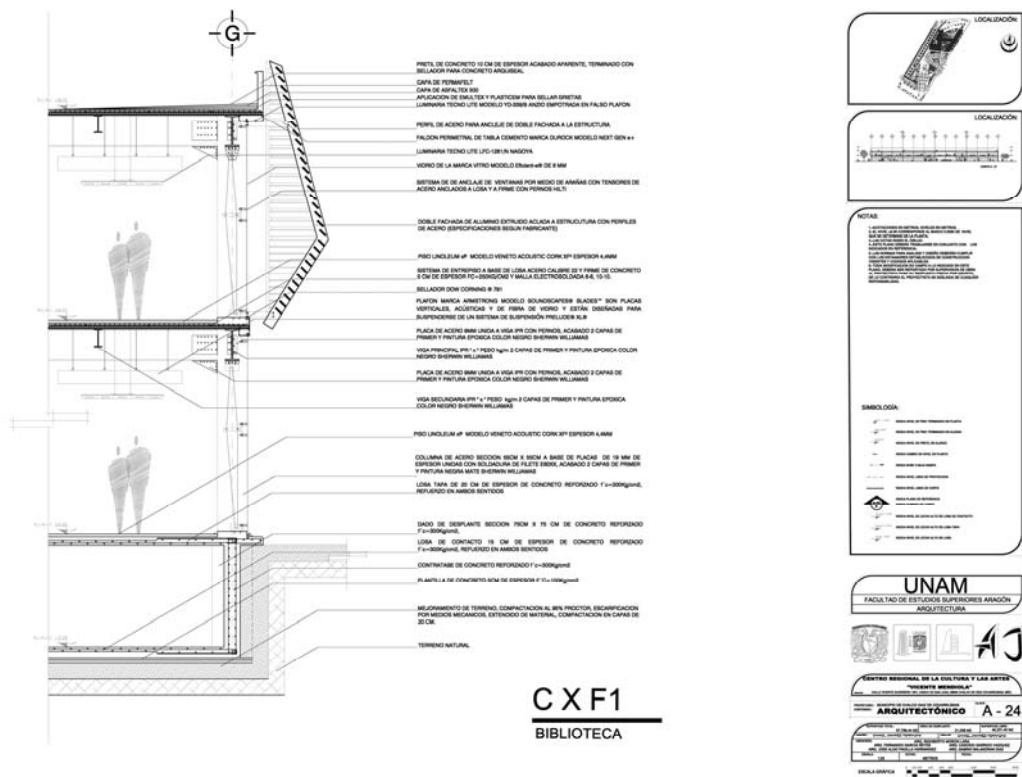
PLANO ARQUITECTÓNICO – CORTE POR FACHADA BIBLIOTECA – A-24 Fuente: Elaboración propia.
